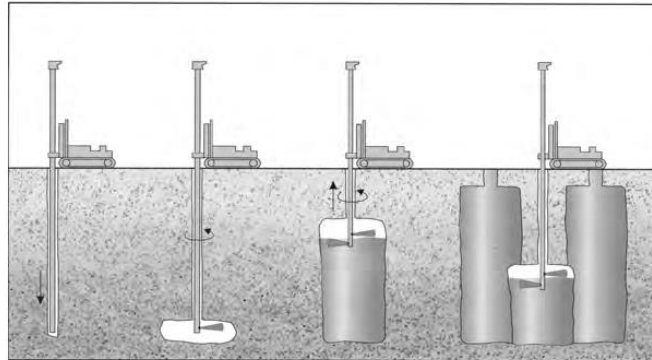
Técnica de Jet grouting (Hayward Baker)
